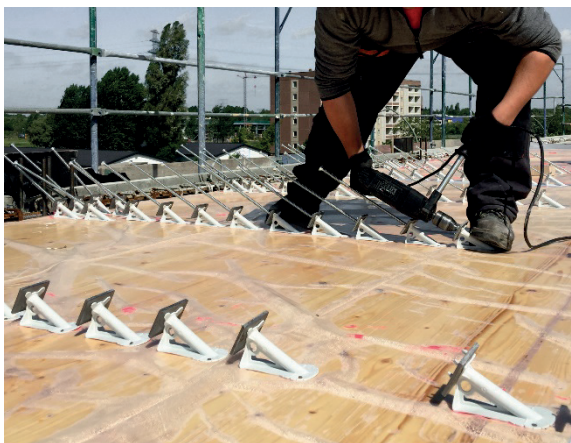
Herstellung einer Holz-Beton-Verbunddecke:
